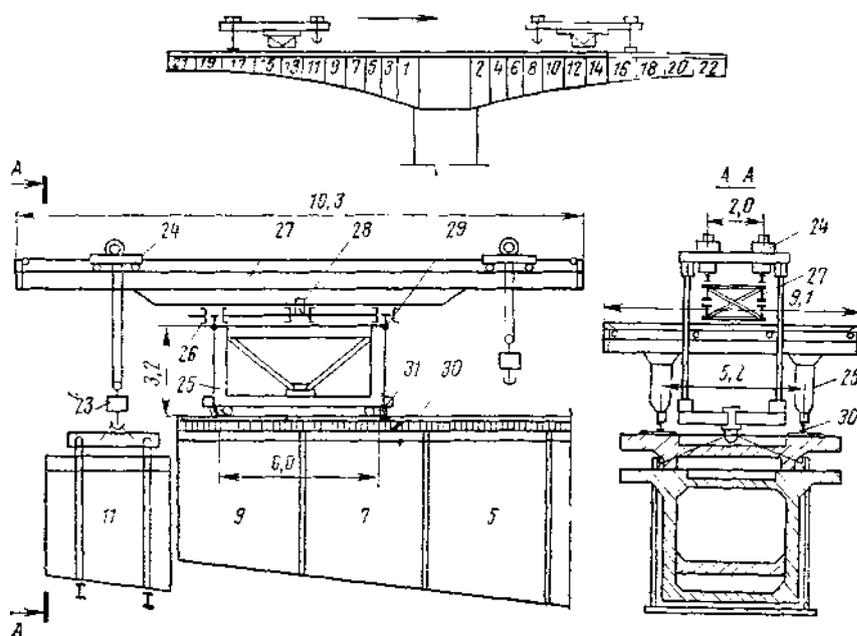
6 Схема навесного монтажа пролетного строения агрегатом СПК 35: 22 – порядковые номера (последовательность установки) блоков; 23 – грузовая траверса, 24 – грузовая тележка; 25 – нижняя подставка-тележка, 26 – поперечные балки, 27 – основная рабочая консоль, 28 – механизм для поперечного движения рабочей консоли, 29 – путь поперечного перемещения рабочей консоли; 30 – путь продольного перемещения агрегата; 31 – захваты
